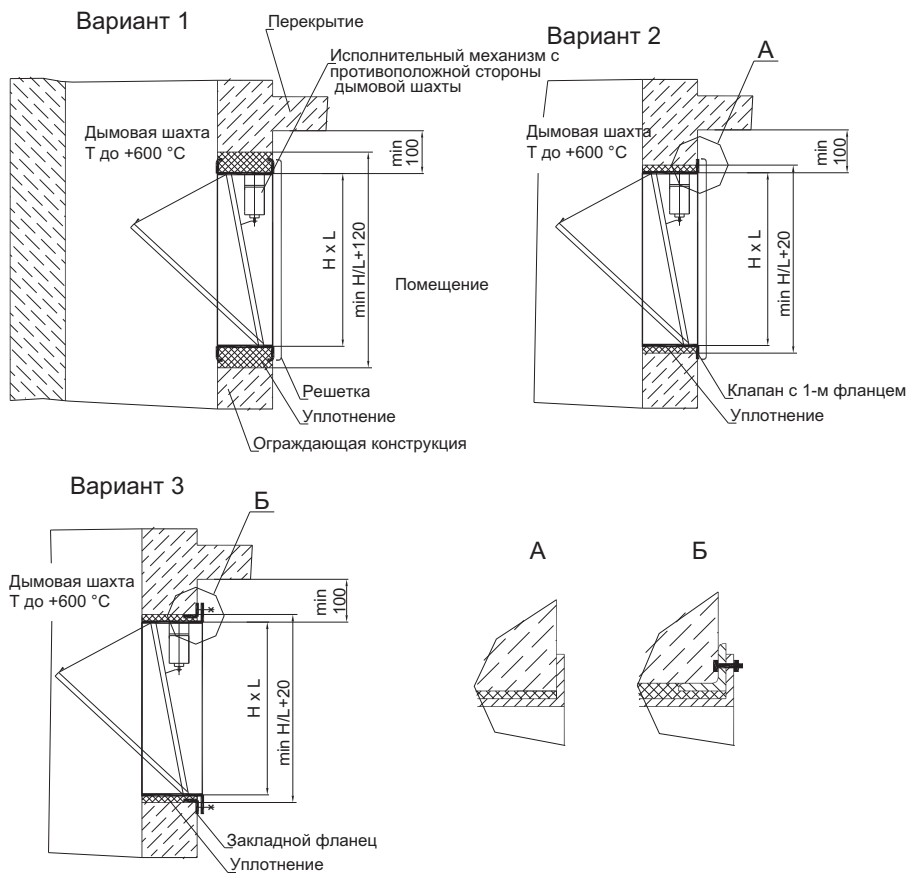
Схема монтажа клапана в противопожарных стенах с бетонной заделкой
